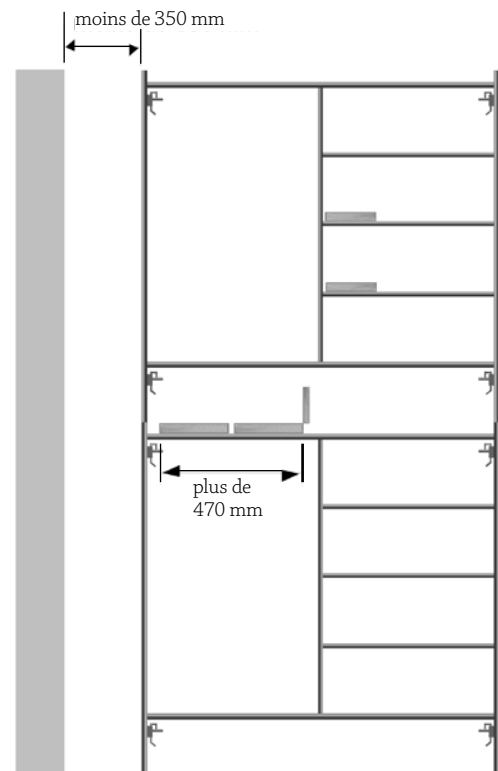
Largeur du plancher et sa distance par rapport à la surface de travail
